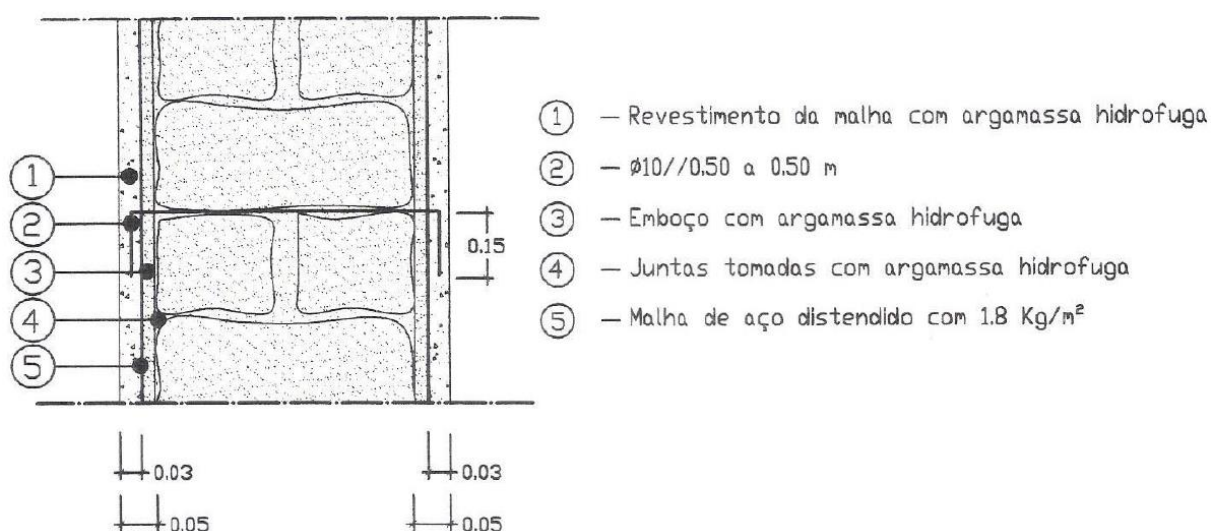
Aplicação de reboco armado nas duas faces da parede [22]
